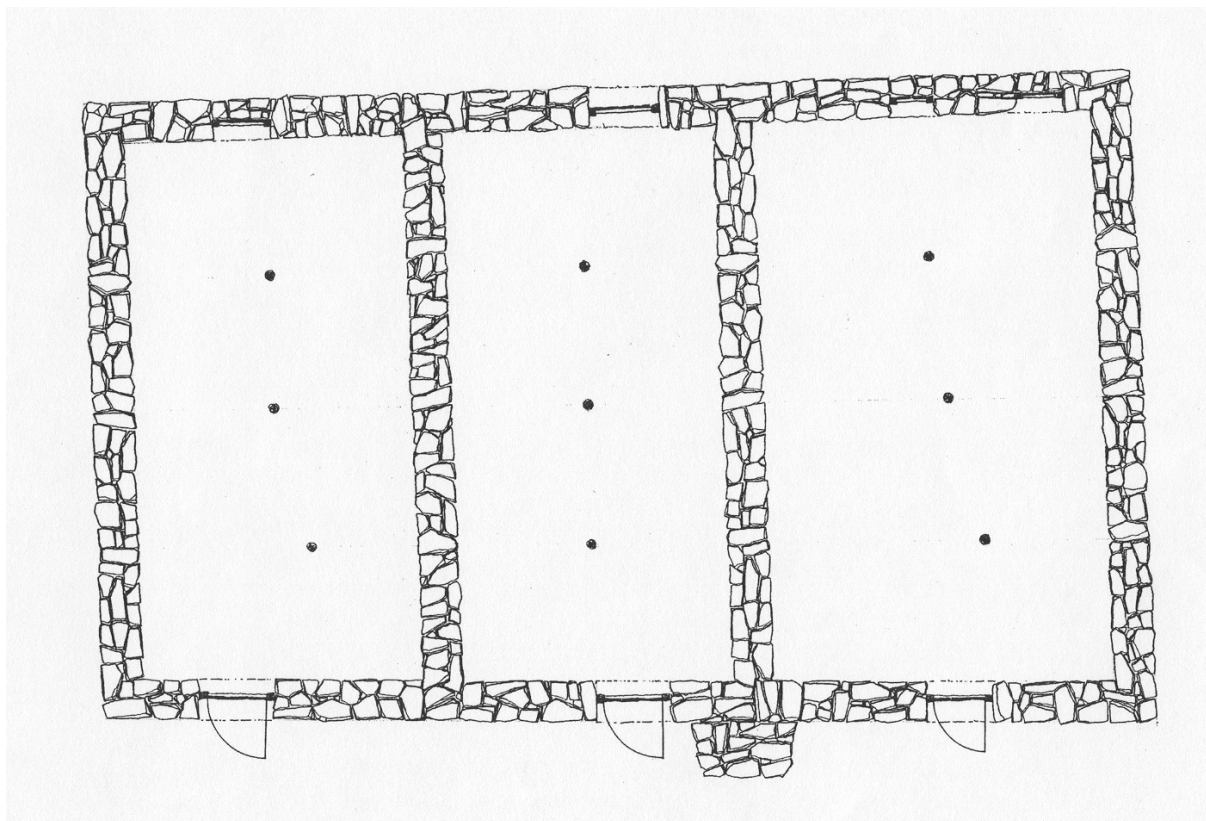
Parideras en Herrería (Guadalajara). Planta.
